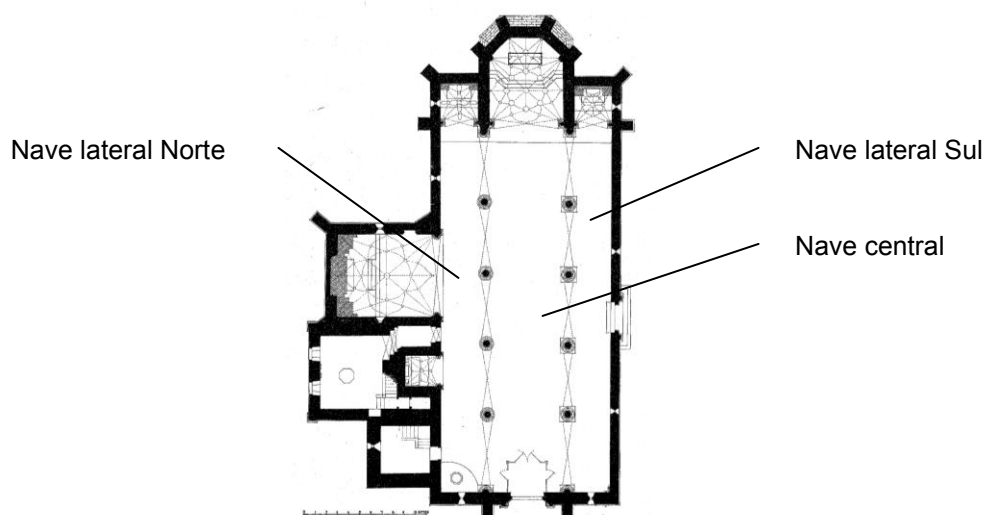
Planta da Igreja Matriz de Caminha [4].
